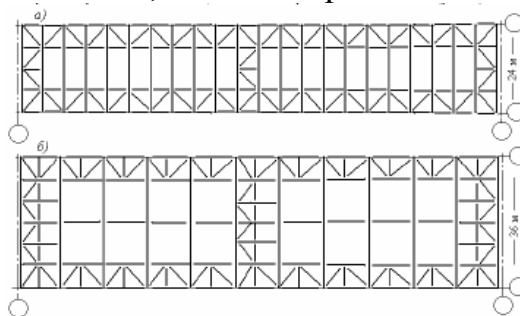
Приклади компонування горизонтальних зв'язків у площині нижніх поясів ферм при кроці ферм 6 м (а) і 12 м (б)
